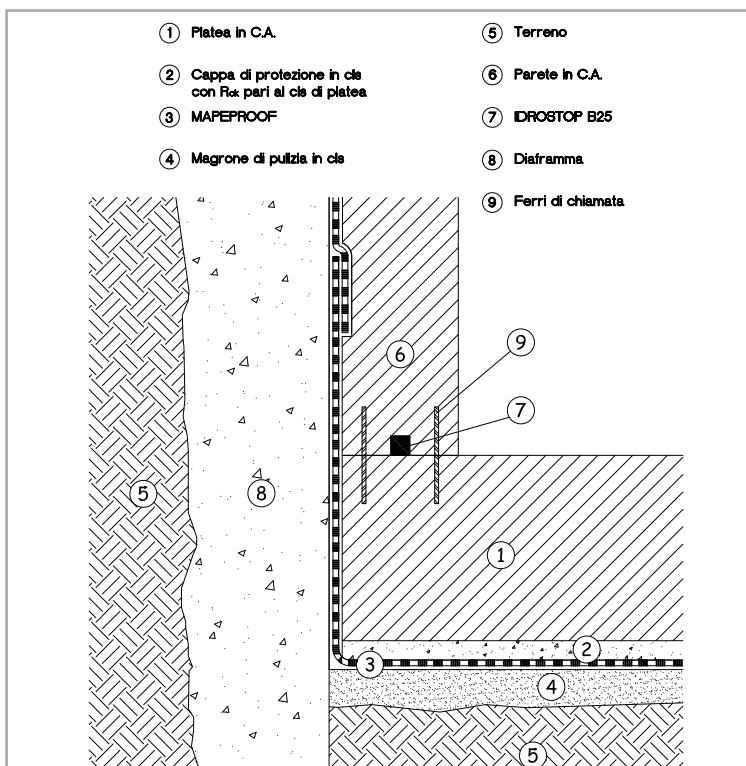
Particolare tecnico dell'applicazione di MAPEPROOF contro un diaframma reso collaborante alla struttura.
